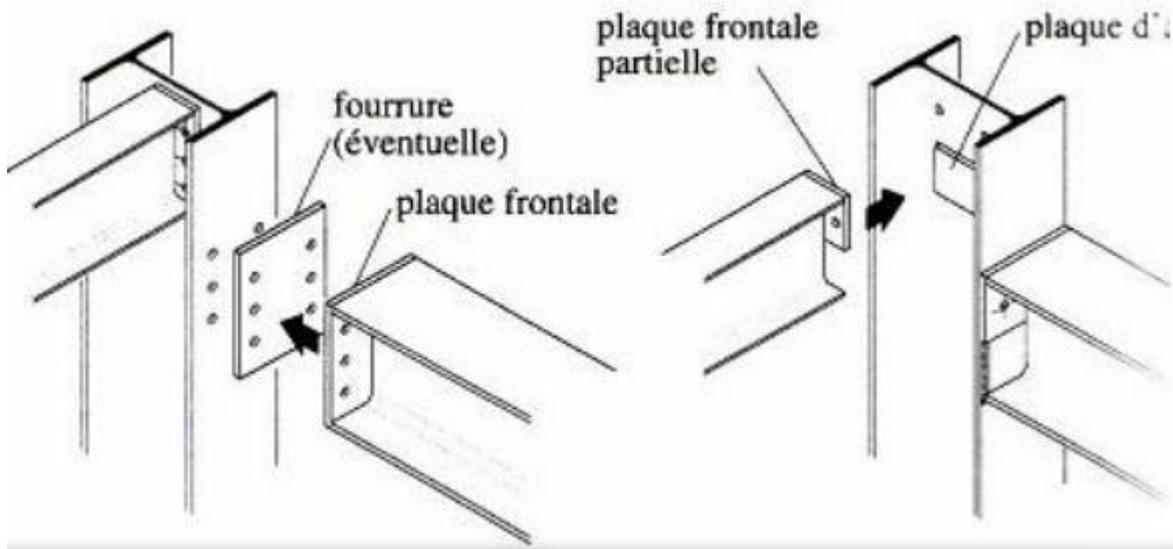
assemblage poteau-poutre/Source : <http://Google image.com>
